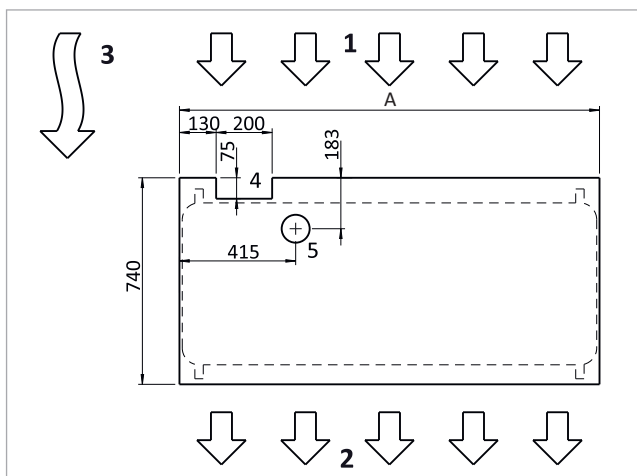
Fondamenta per SolvisLea (vista dall'alto)
